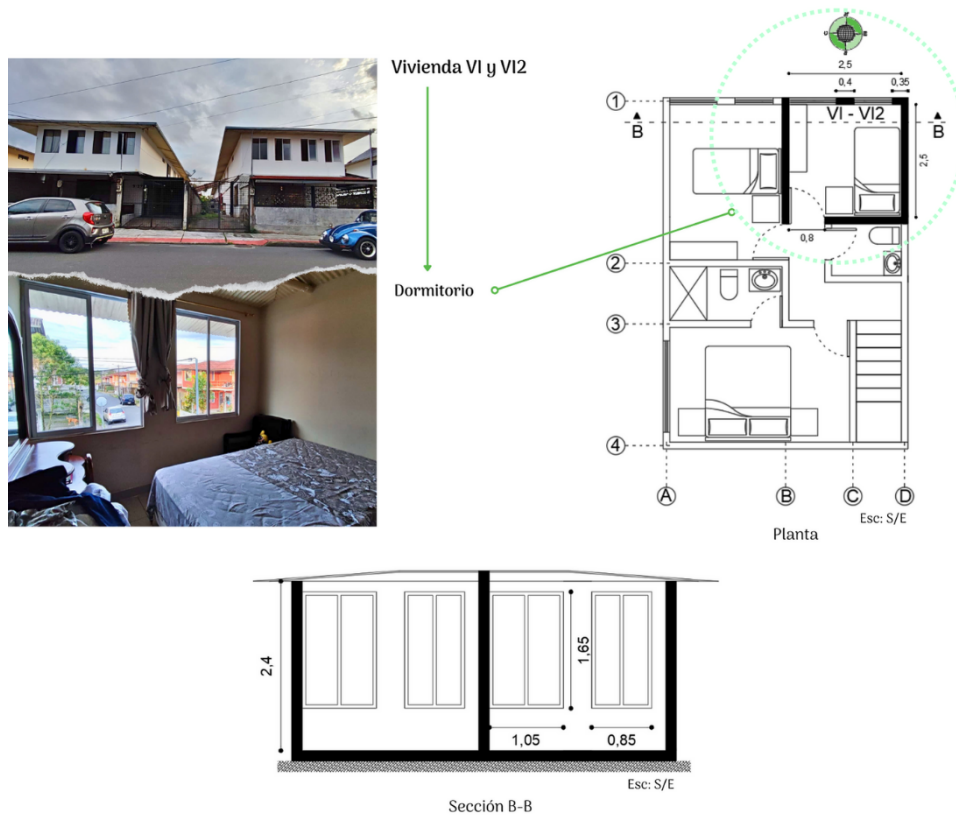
Planta y sección arquitectónica de la vivienda VI y VI2.
